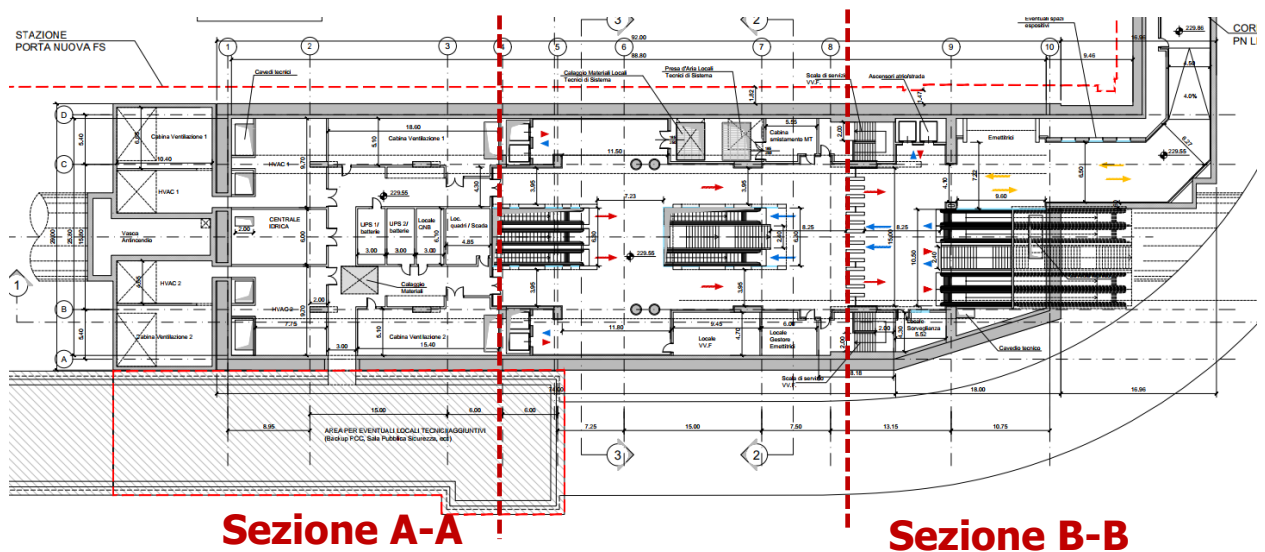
Stralcio planimetria stazione Porta Nuova con indicazione della sezione di calcolo A-A e Sezione B-B
